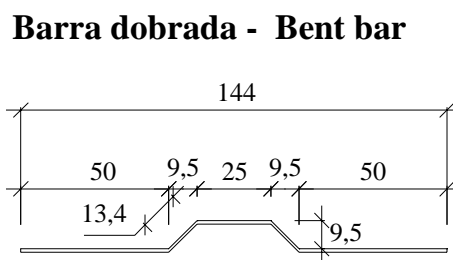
Armadura de cisalhamento das lajes L5 e L6 – barra dobrada
